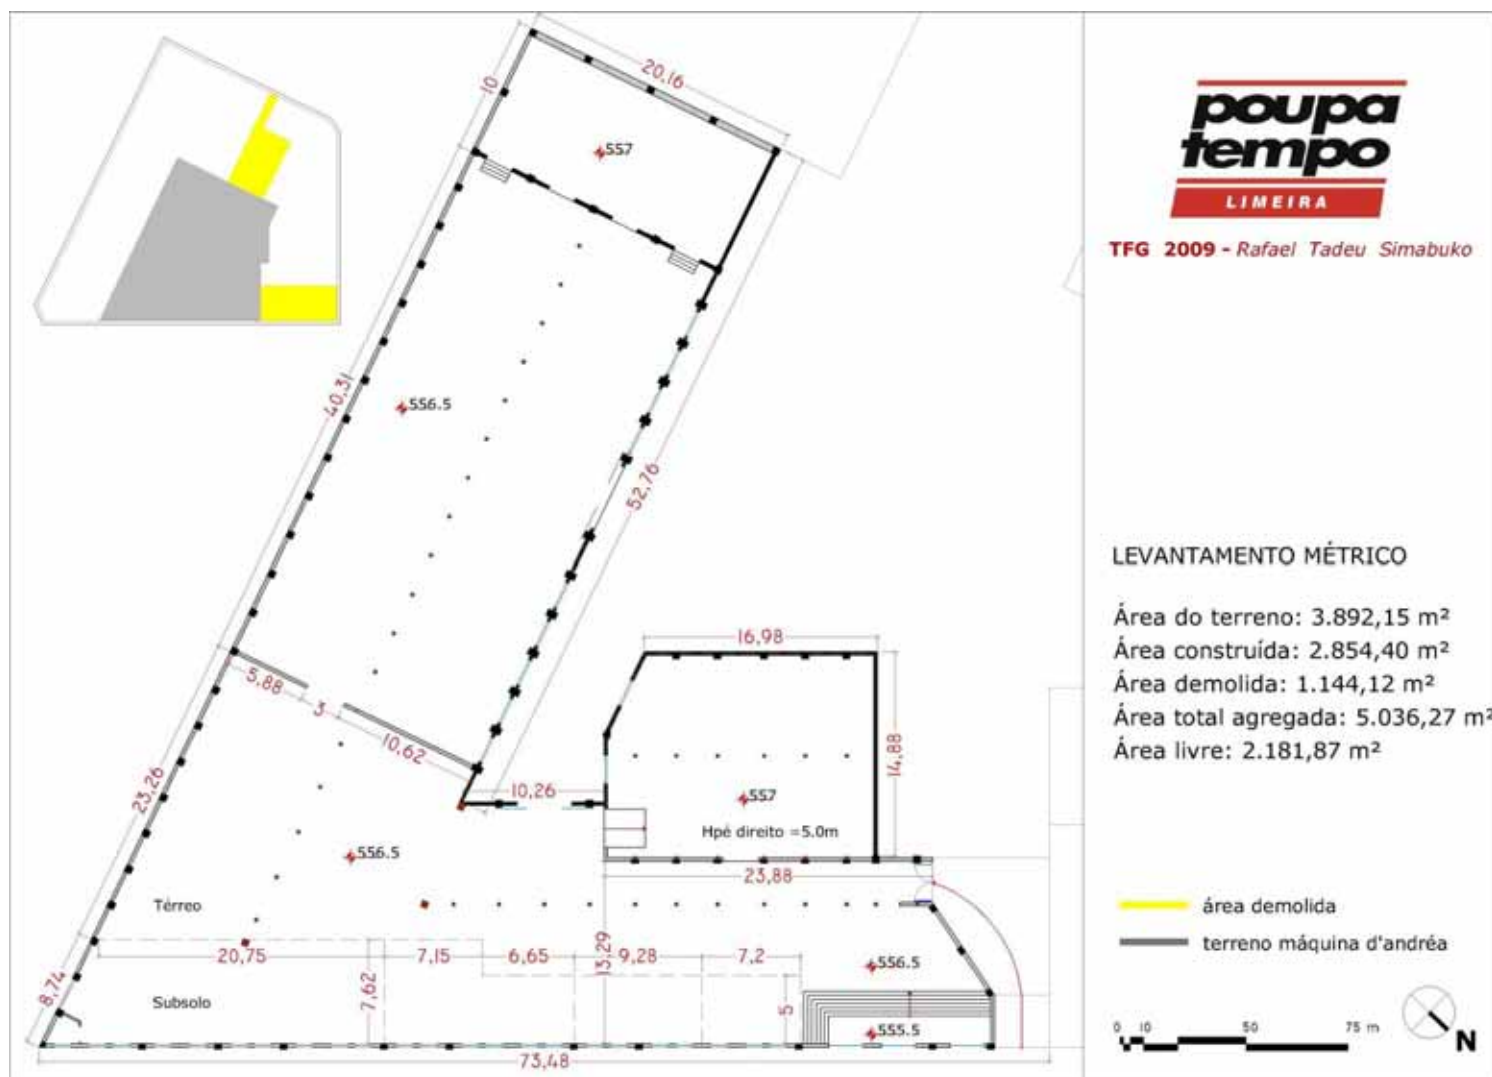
Levantamento métrico - Planta reconstituída da Indústria Máquina D'Andréa
